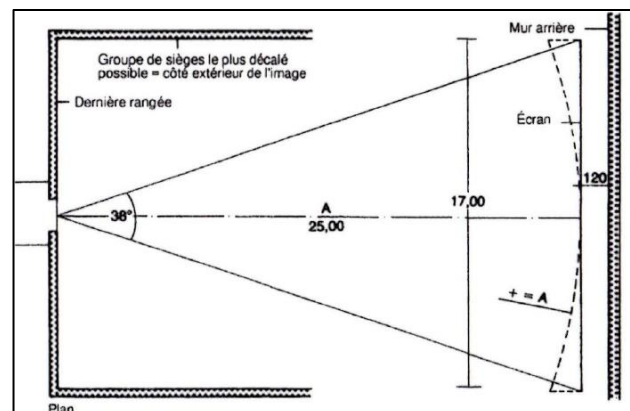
Plan d'une salle de cinéma, (source : Neufert 10^{ème} édition).
